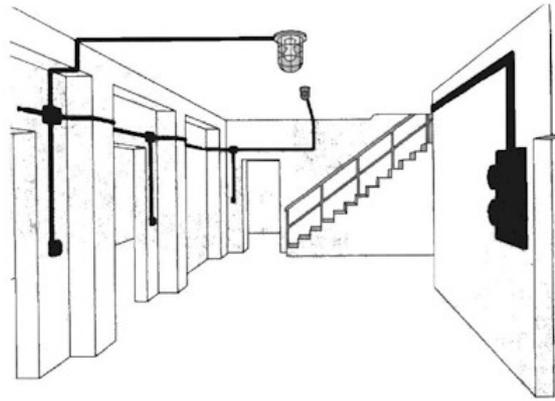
Impianto elettrico con distribuzione a vista in canalette di PVC
